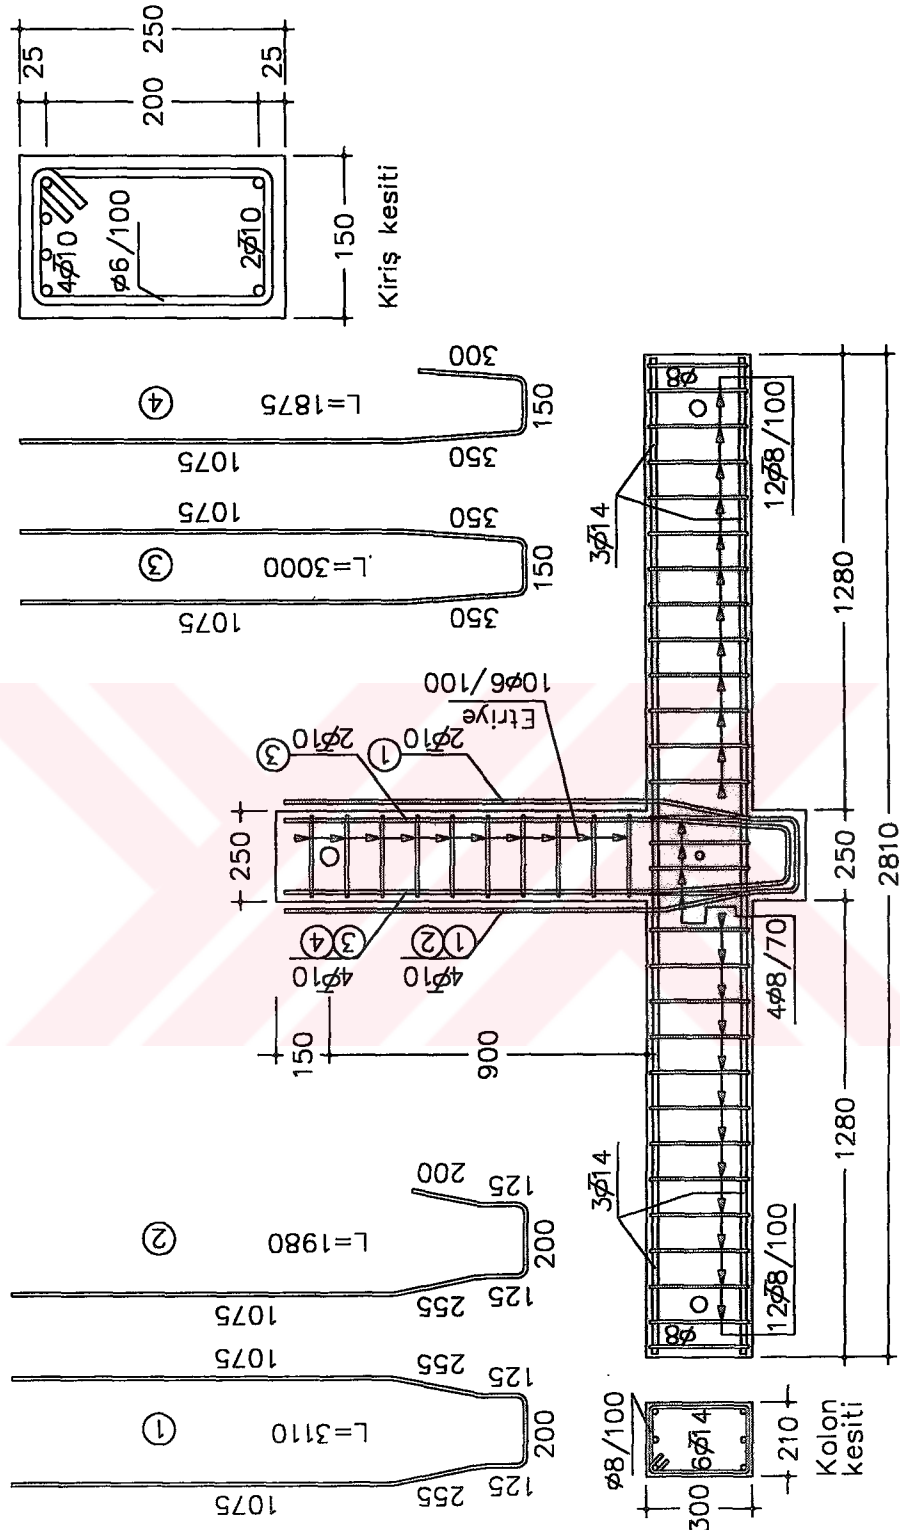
M3S elemanın boyut ve donatı detayı
